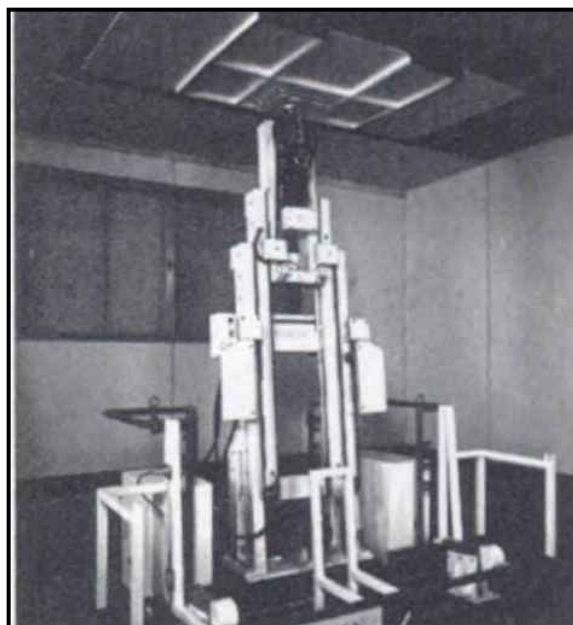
Robot para colocación de planchas CFR-1. *Construction Robots. The search for new building technology in Japan.
